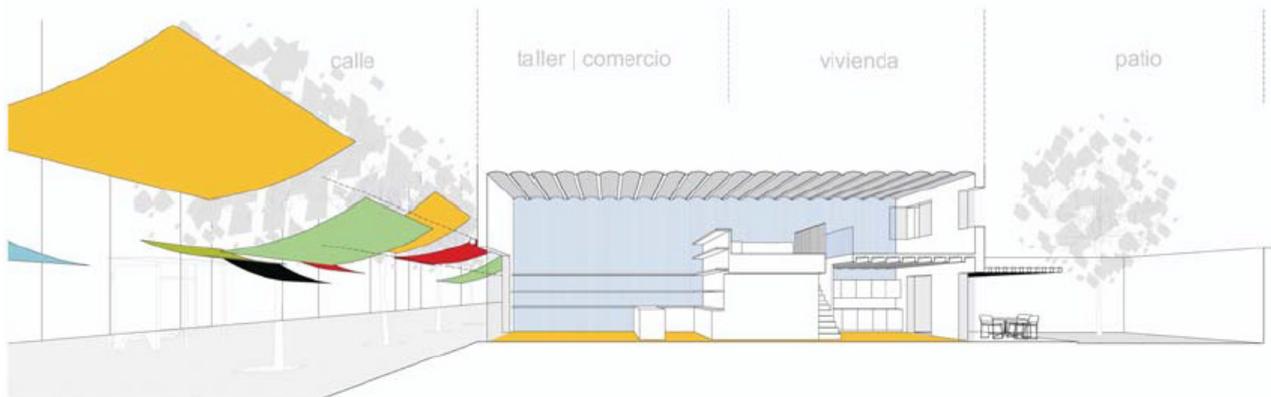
(Xavier Monteys, Relación la Planta Baja y la calles, 2010).
